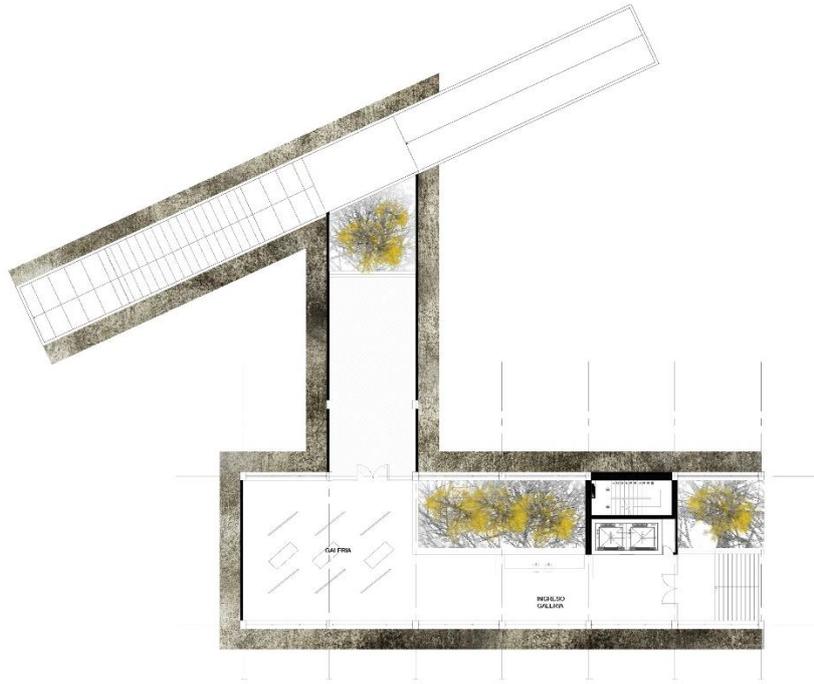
Planta Subsuelo Galeria. Nivel – 1.80. Elaboración propia.
